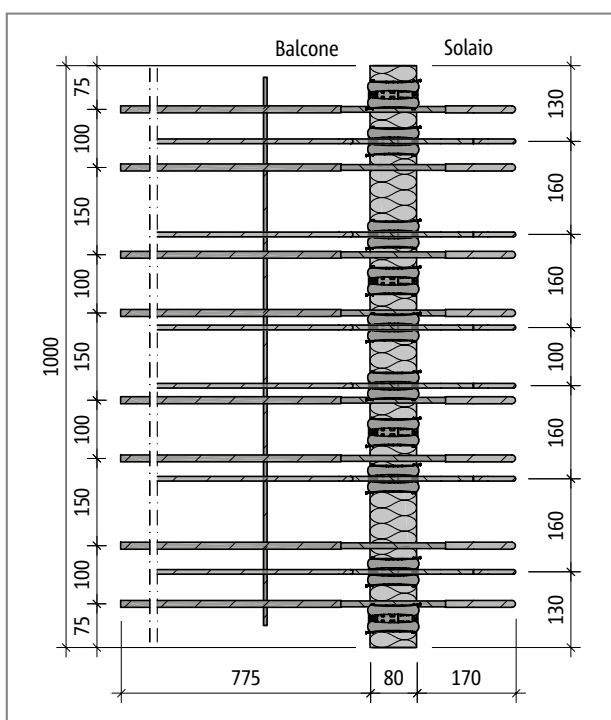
Schöck Isokorb® tipo K70M-UZ: pianta del prodotto
